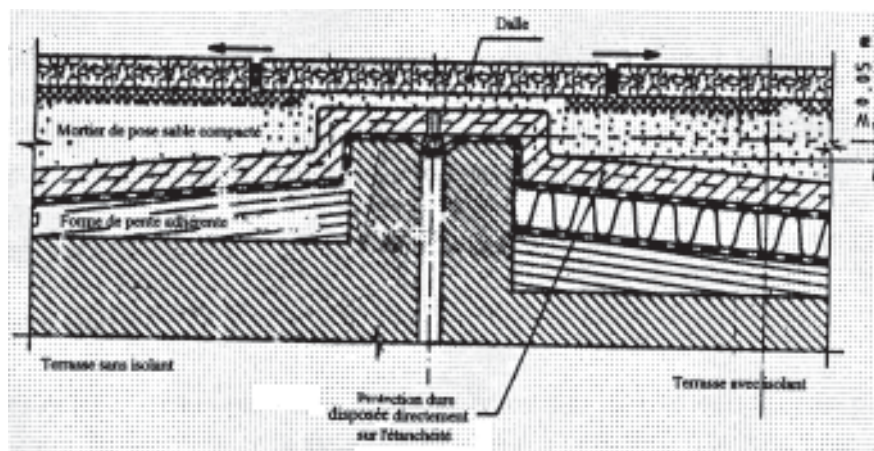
Terrasse accessible avec protection dure traditionnelle
